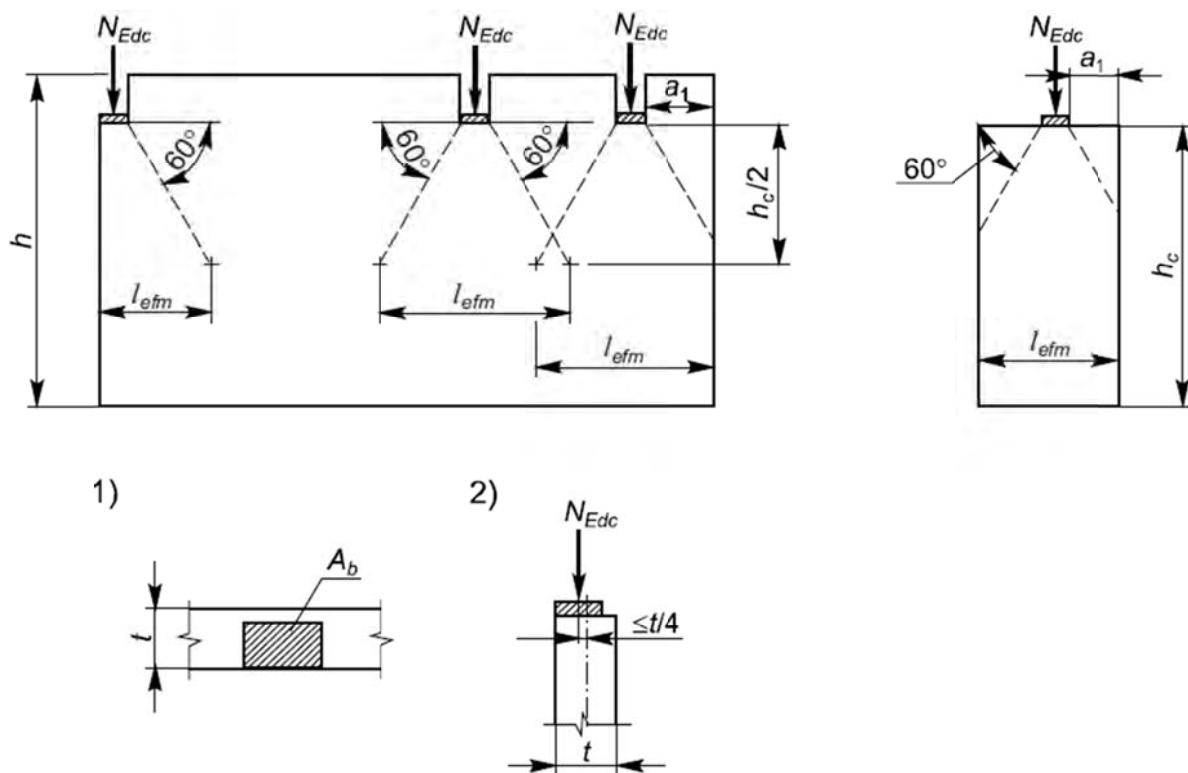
Схема нагружения для расчета стен, воспринимающих сосредоточенные (локальные) нагрузки (базовый метод):
